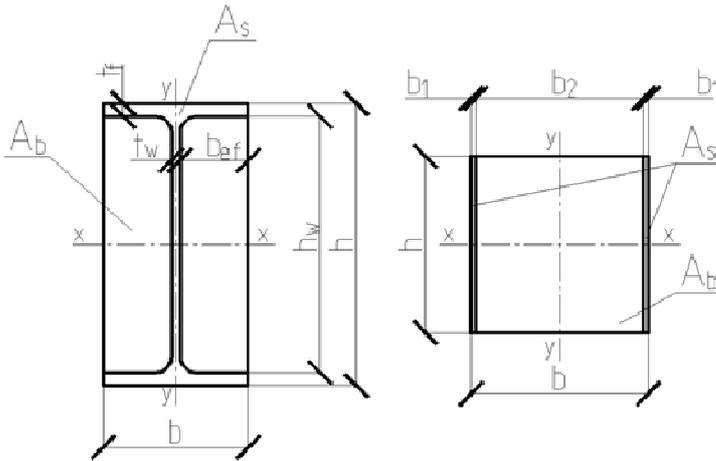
Розрахункові схеми поперечних перерізів стиснутих елементів: а) двотавр з боковими порожнинами, заповненими бетоном; б) стиснутий елемент, армований сталевими листами
